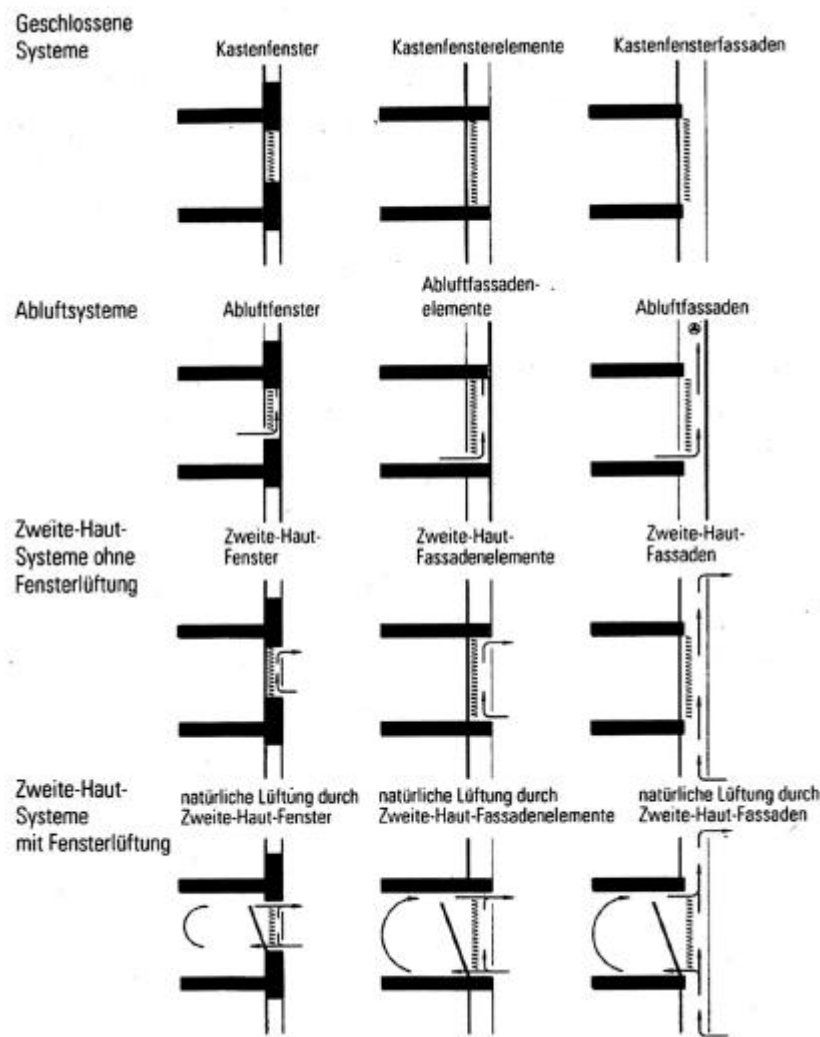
Typische Fassadenvarianten, Quelle: Doppelfassaden S. 9
